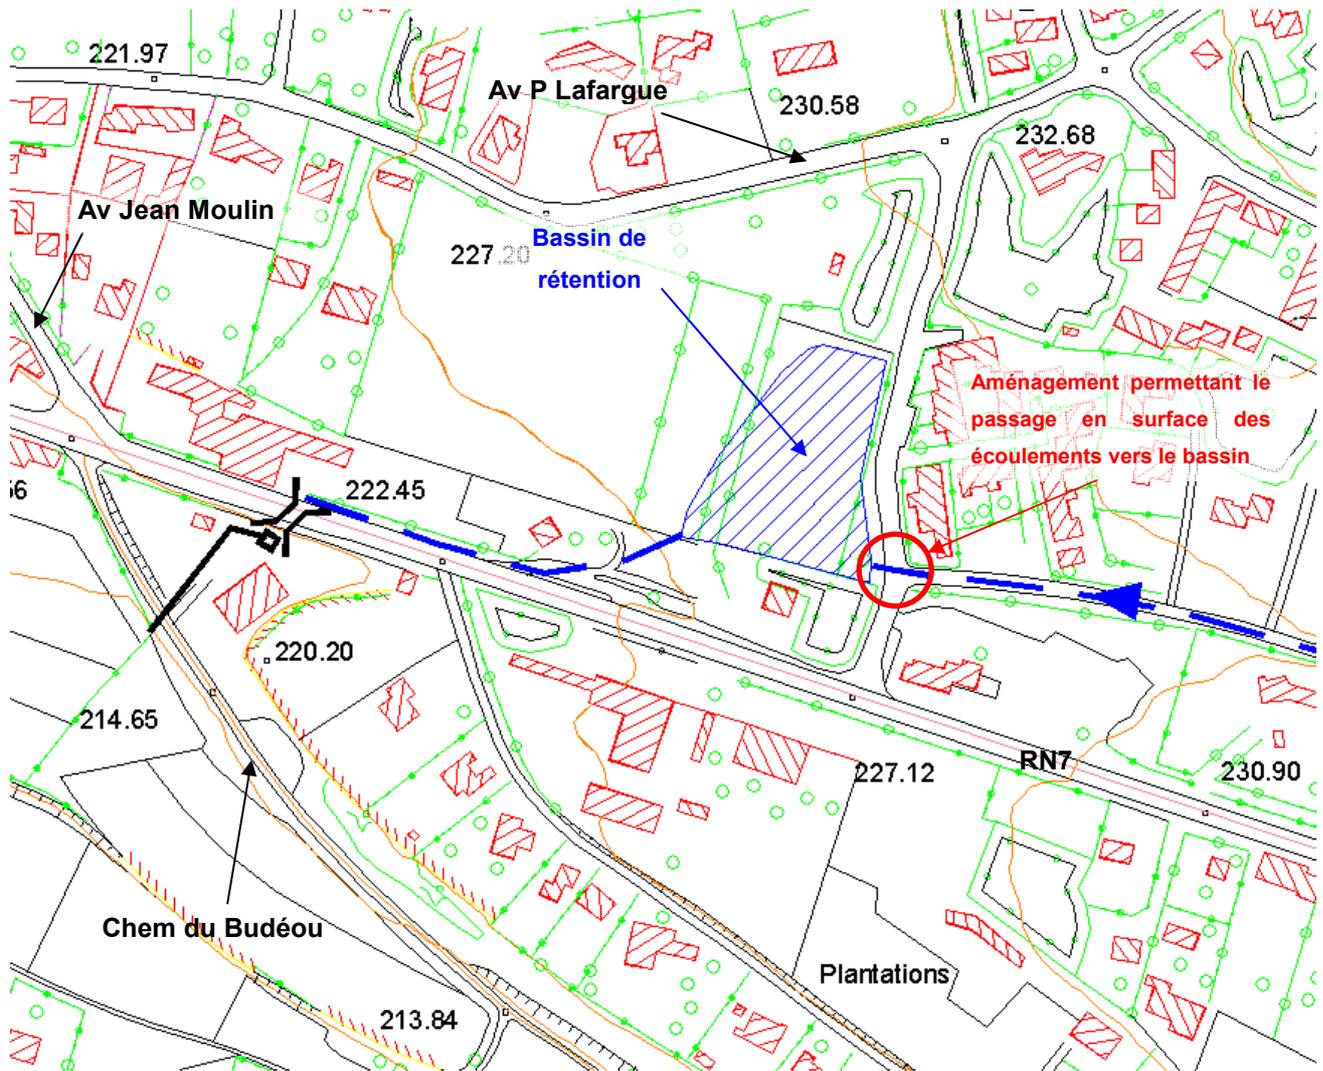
AMENAGEMENT N°5 – VUE EN PLAN
